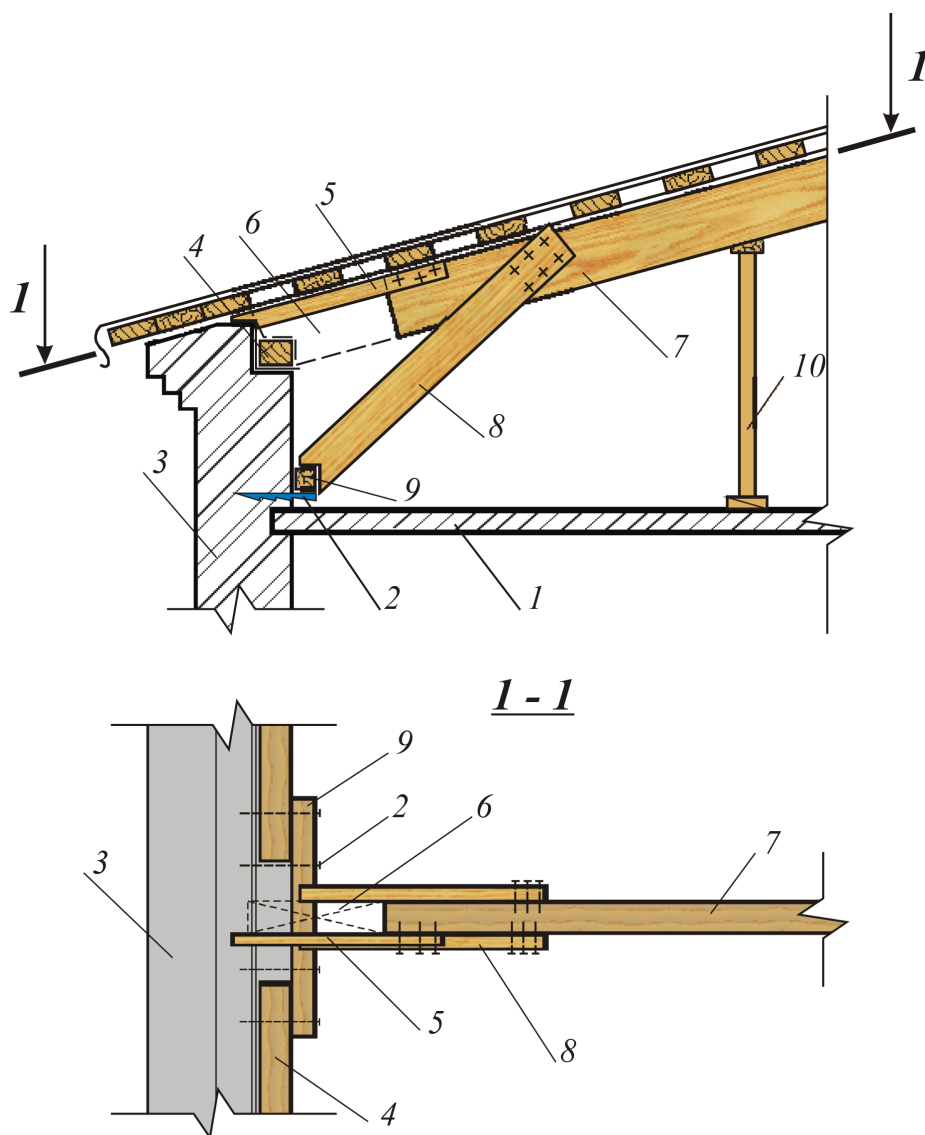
Усиление концов стропильных ног подбалкой: 1 – чердачное перекрытие; 2 – костыль; 3 – стена; 4 – мауэрлат; 5 – кобылка; 6 – поврежденный участок; 7 – «здоровый» участок стропильной ноги; 8 – накладка; 9 – подбалка; 10 – временные стойки [11]
